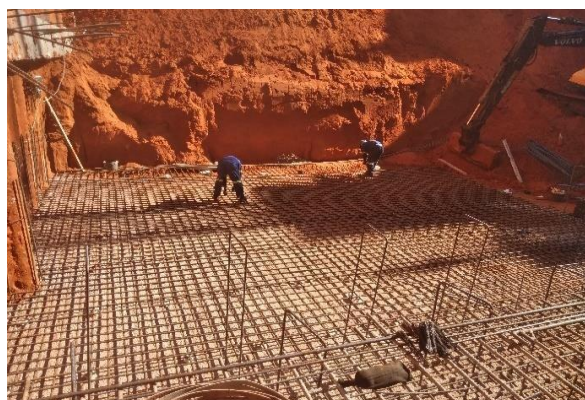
Amarração dos cavaletes (Fonte: Autor)
